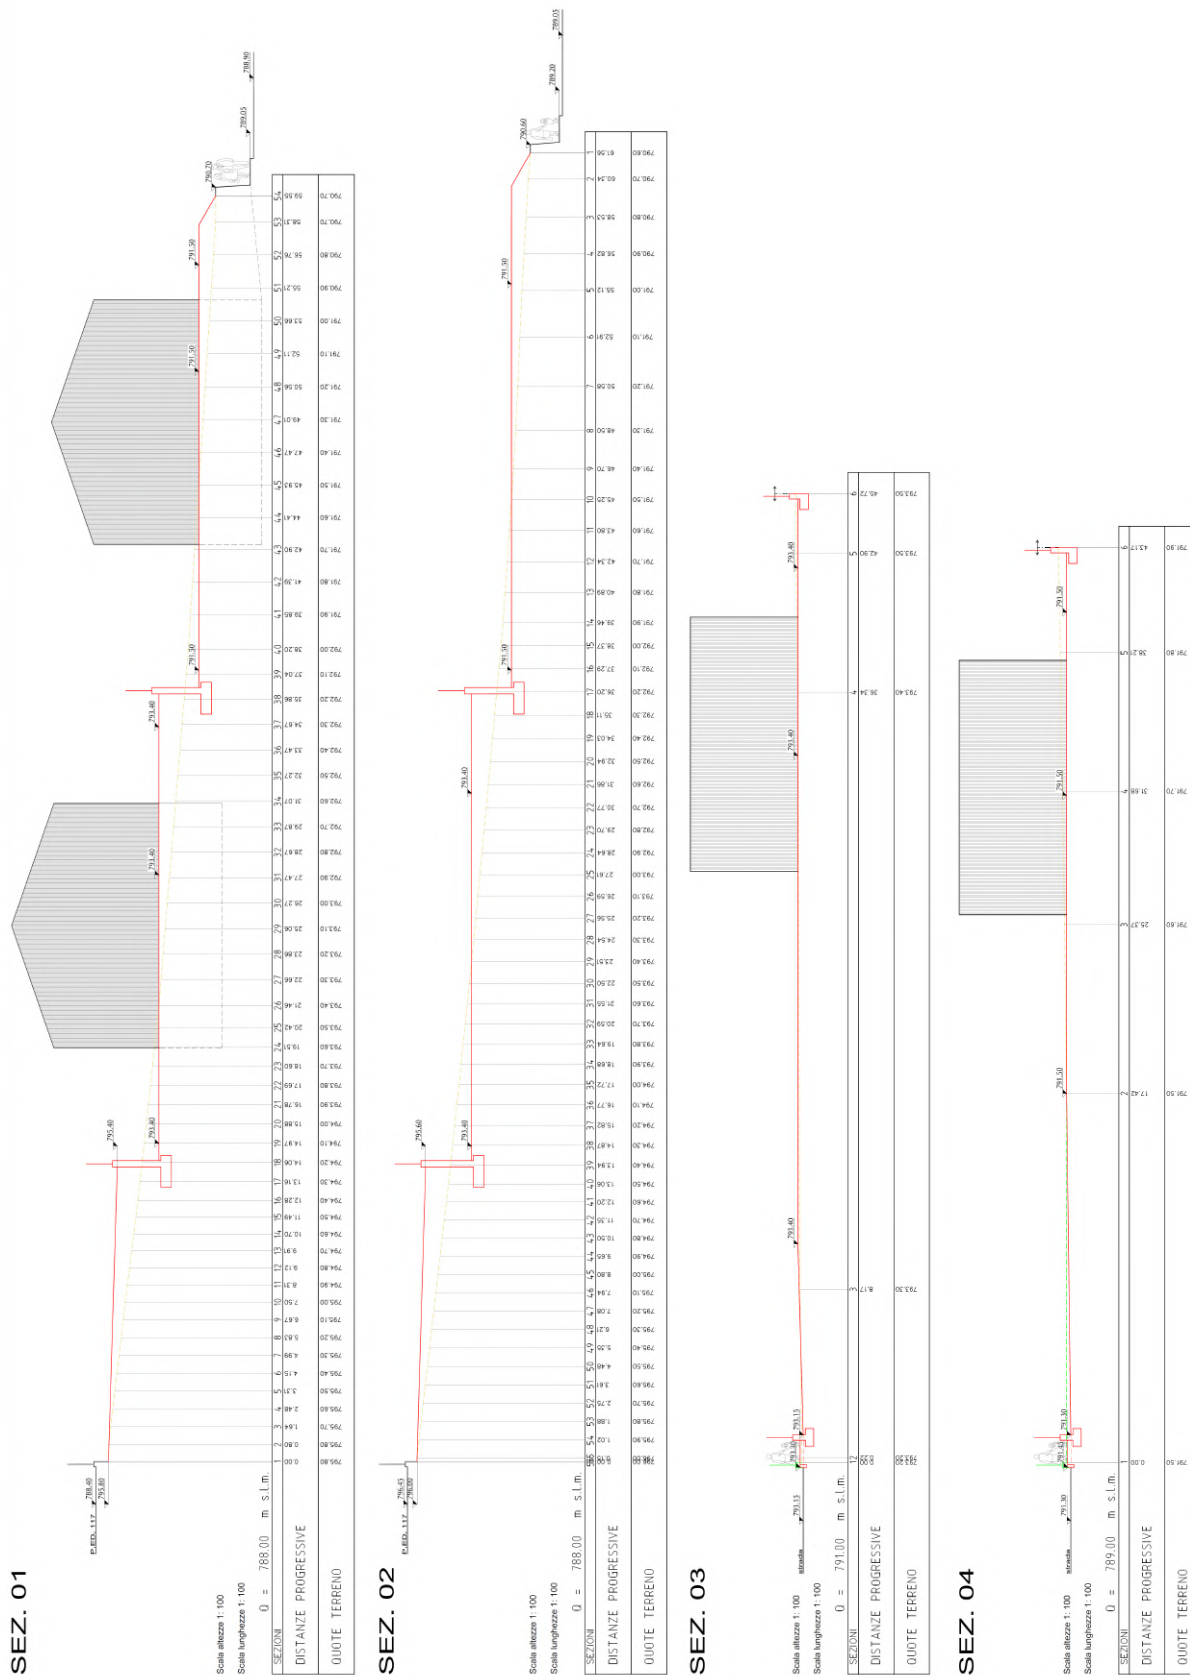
Estratto SEZIONI LOTTO (TAV. 06) da progetto redatto dall'Arch. Italo Bertolini.
